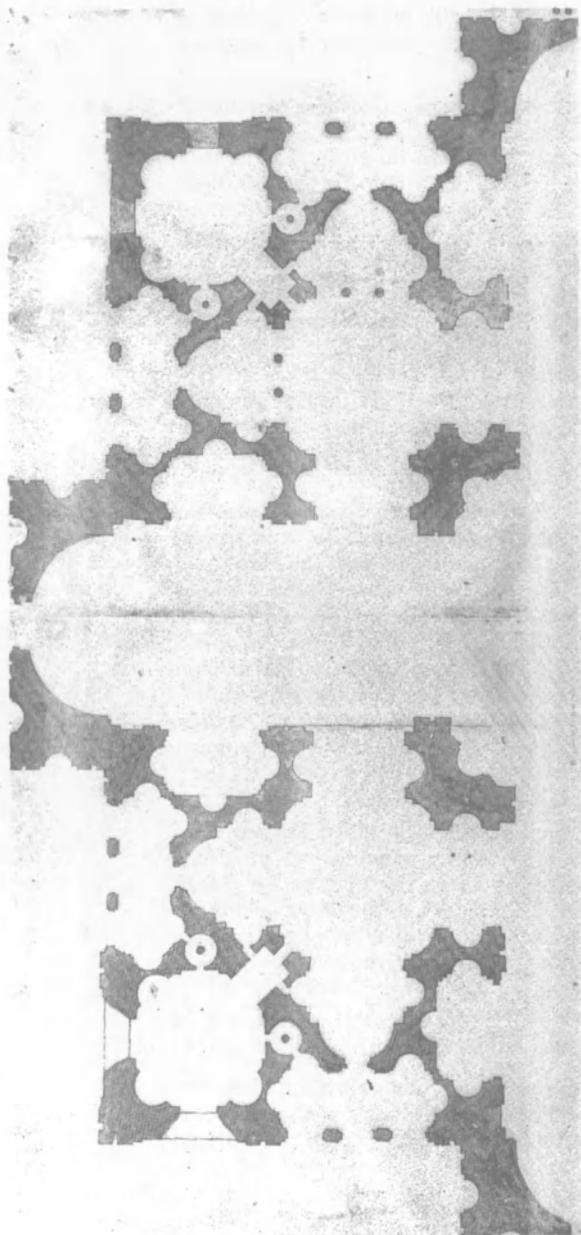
Dibujo de Bramante para la planta de San Pedro (n.º 1) (Galería de los Uffizi, de Florencia).
